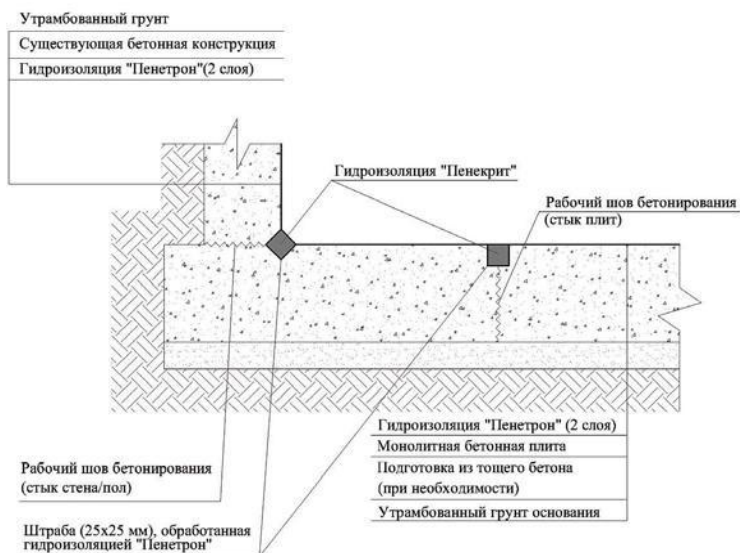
Устройство гидроизоляции в швах примыкания к полу
